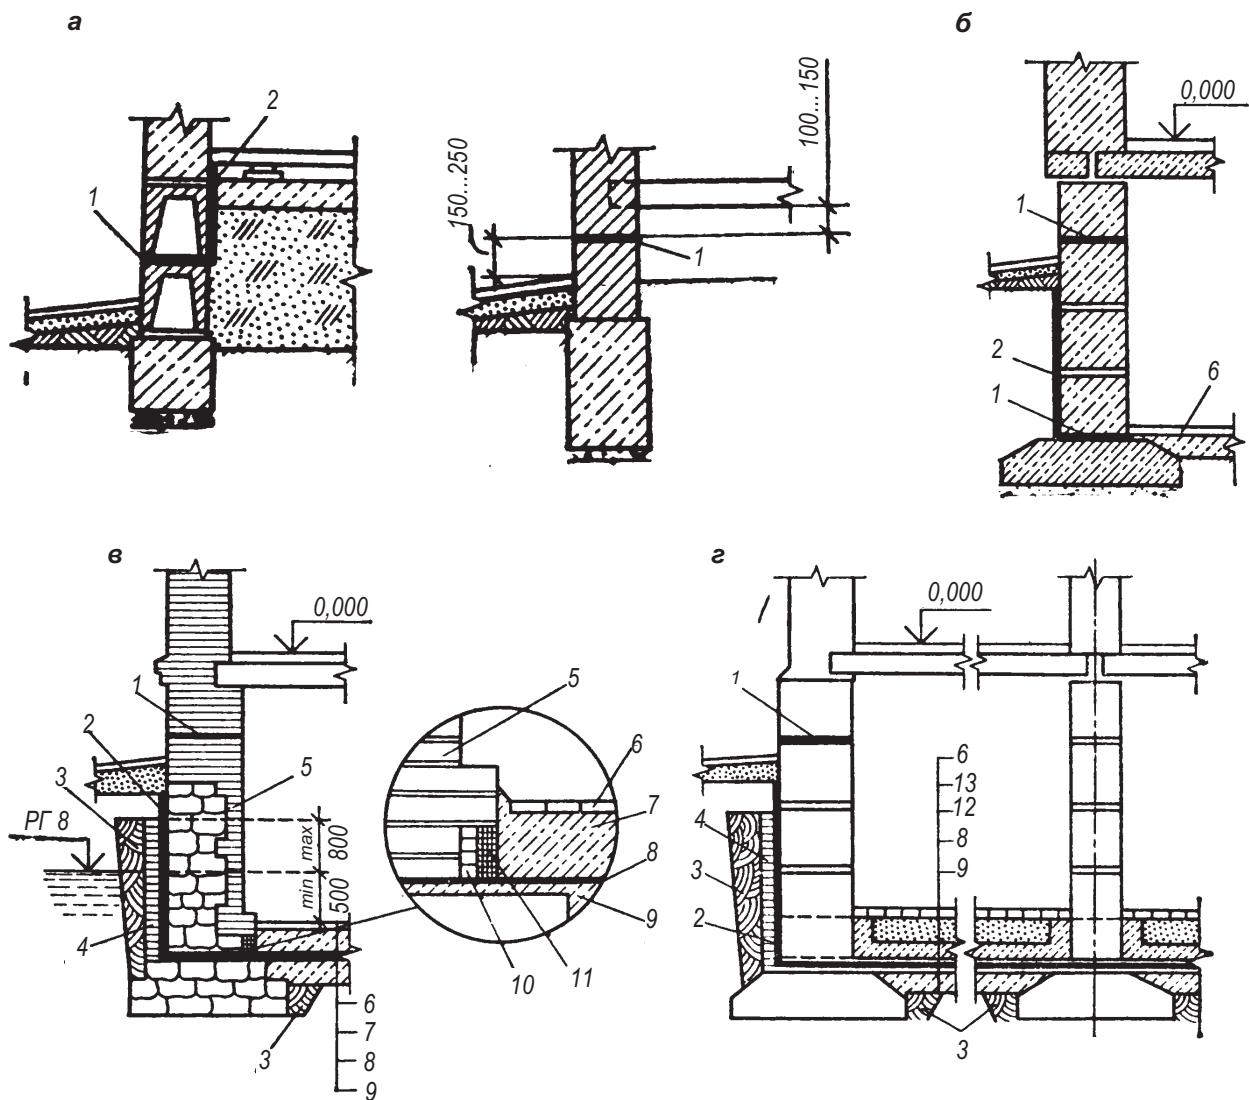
Ізоляція будівлі від ґрунтової води:
